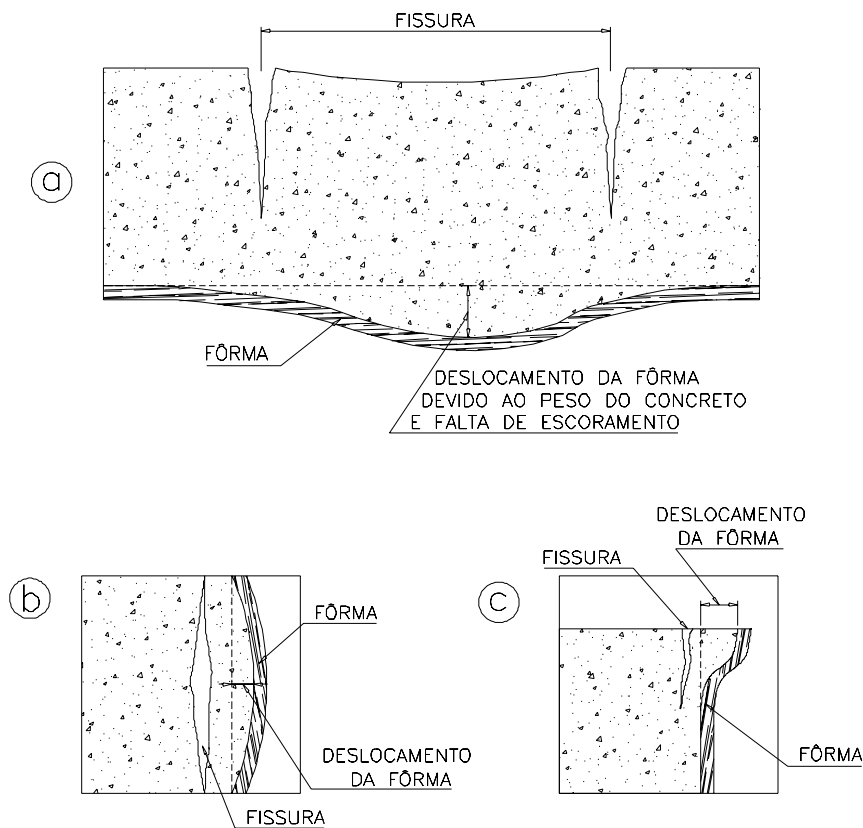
Fissuras no concreto devido ao deslocamento das fôrmas.
